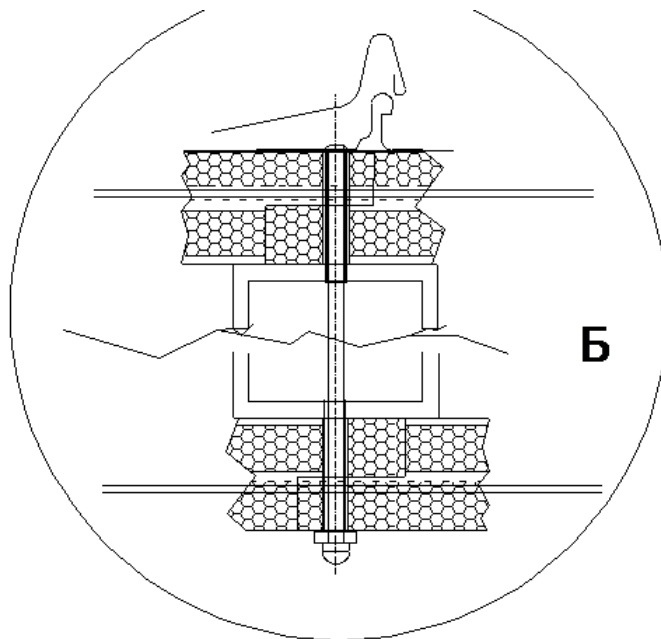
Узел соединения кровельной «термопанели» со стропилами и нижней подшивкой
